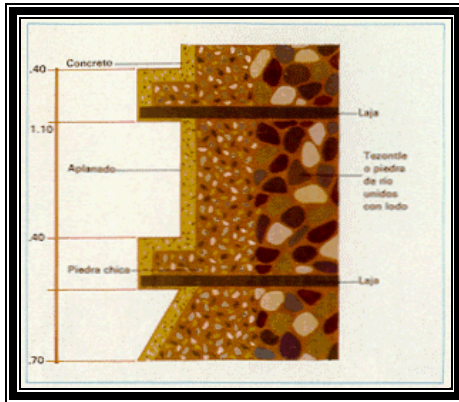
Esquema que explica la construcción de tablero sobre talud
